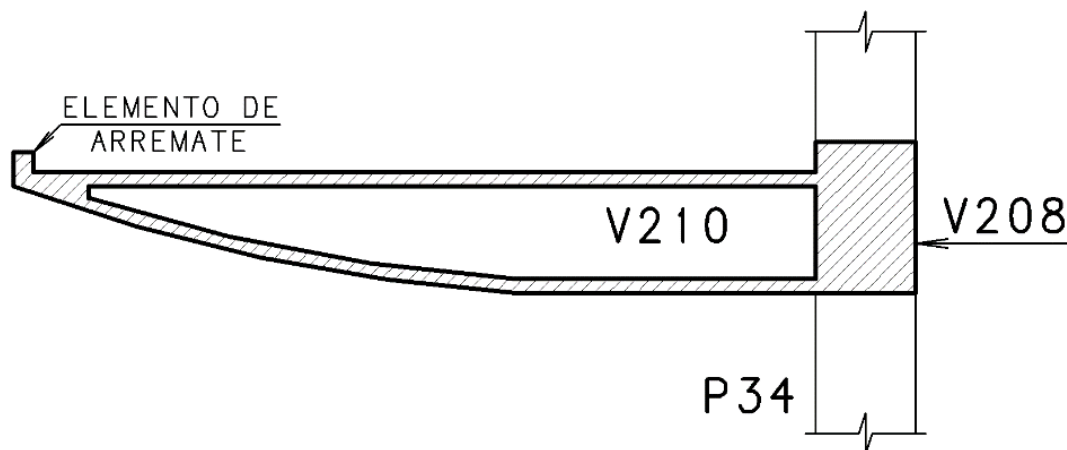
17 - Corte parcial B-B da forma do 1º pavimento – Marquise em corte.
